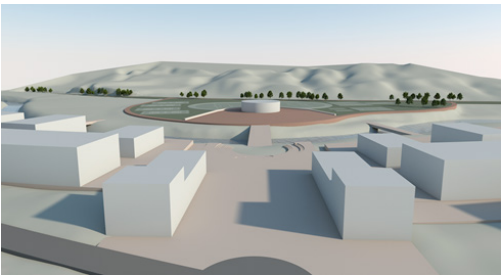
/ Imagen del Plan Masa-Vista desde el Oeste-CRAI
